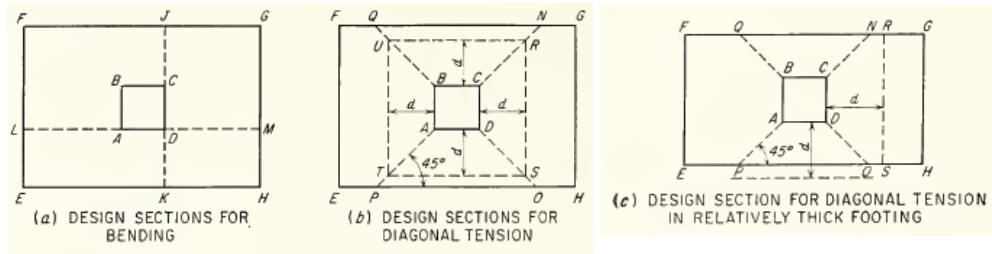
Secciones referencia cálculo zapatas aisladas. Dunham [11].
